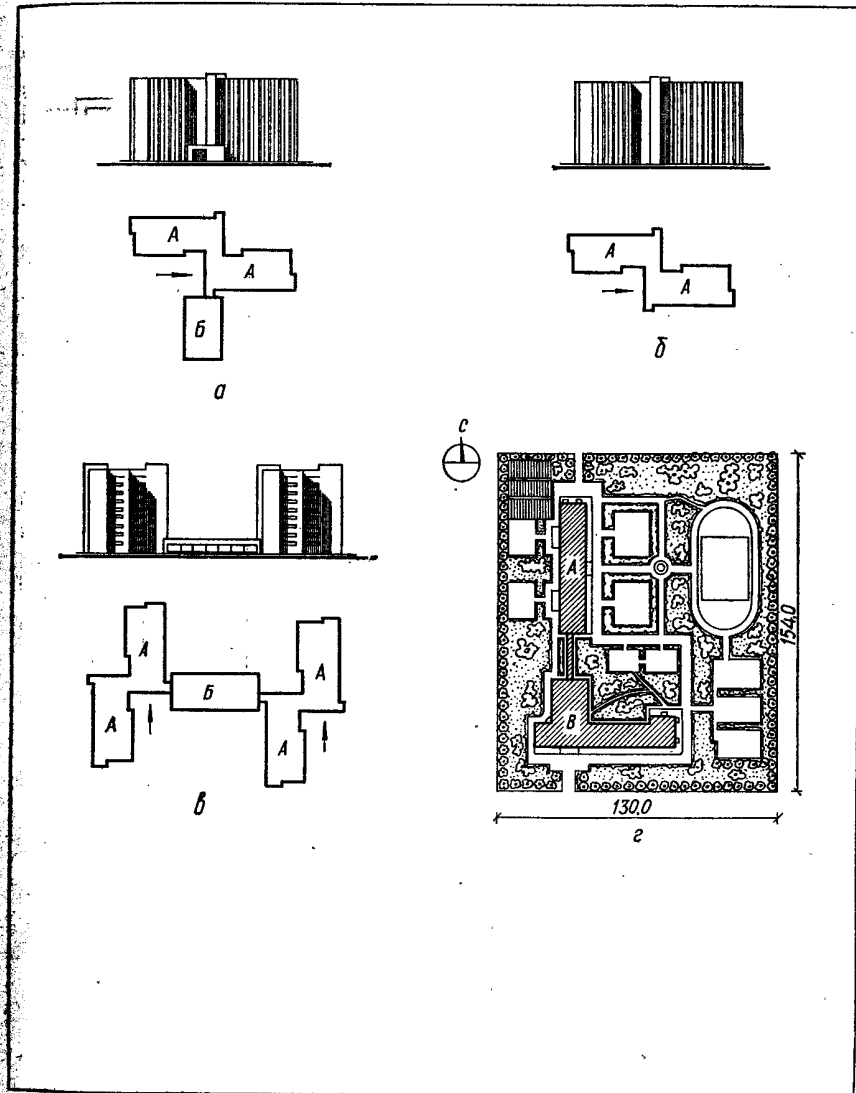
Блокировка спальных корпусов общежитий с блоками обслуживания и учебными корпусами:
